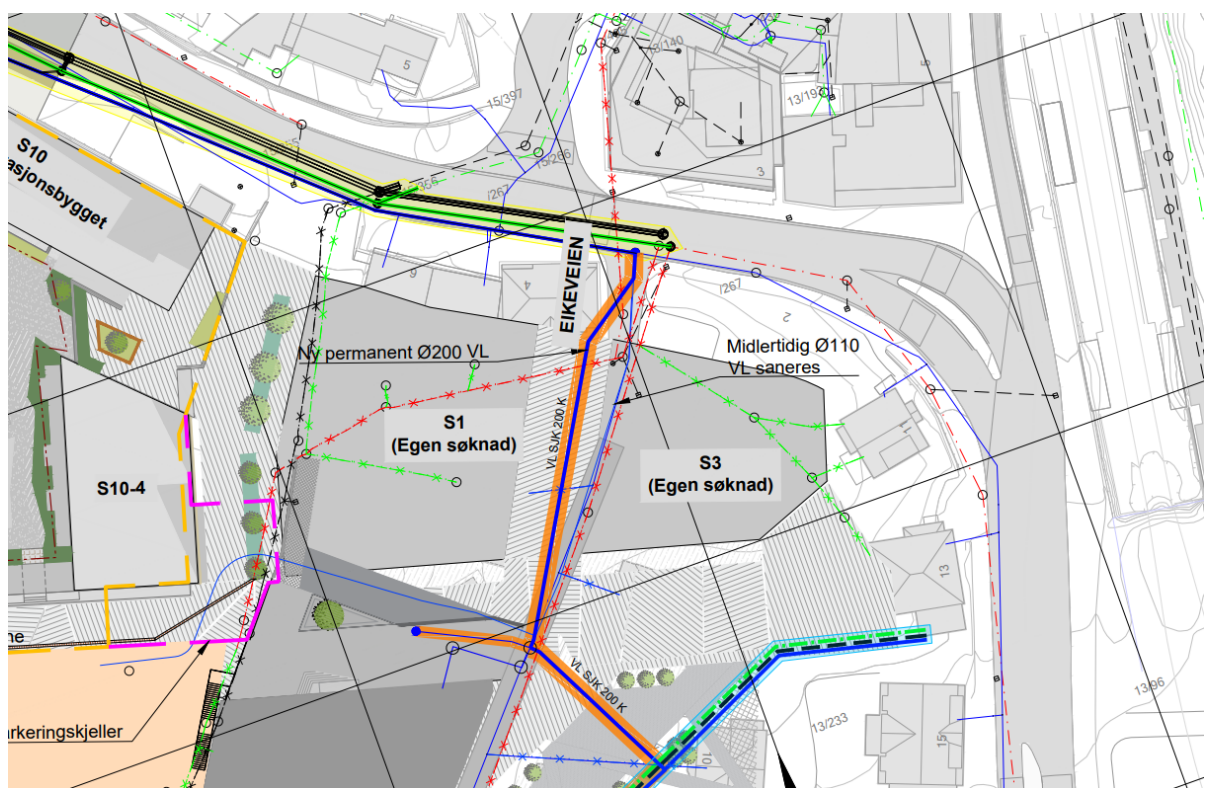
Utsnitt fra tegning 202, revidert 07.04.2017, VA-rammeplan Mindemyren (revisjon 03), nordpilen peker mot høyre, planområdet til sykkelvegen ligger øst for det aktuelle planområdet
